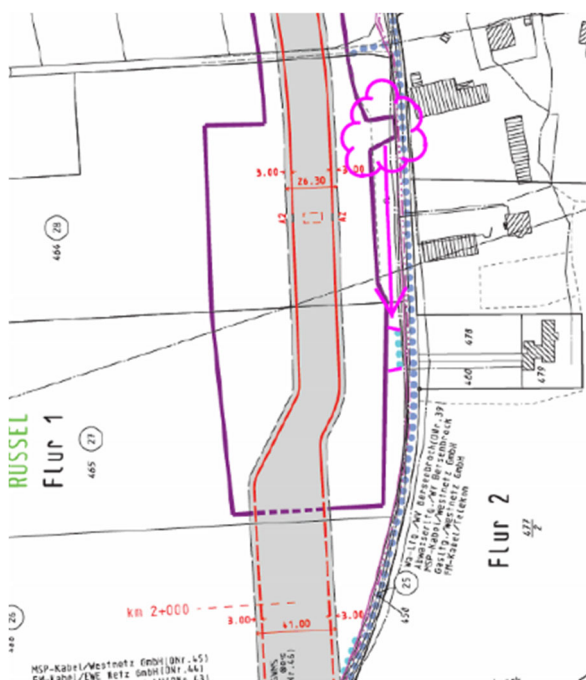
Bl. 4260 Änderung der Zufahrt BE-Fläche Walsumer Straße
